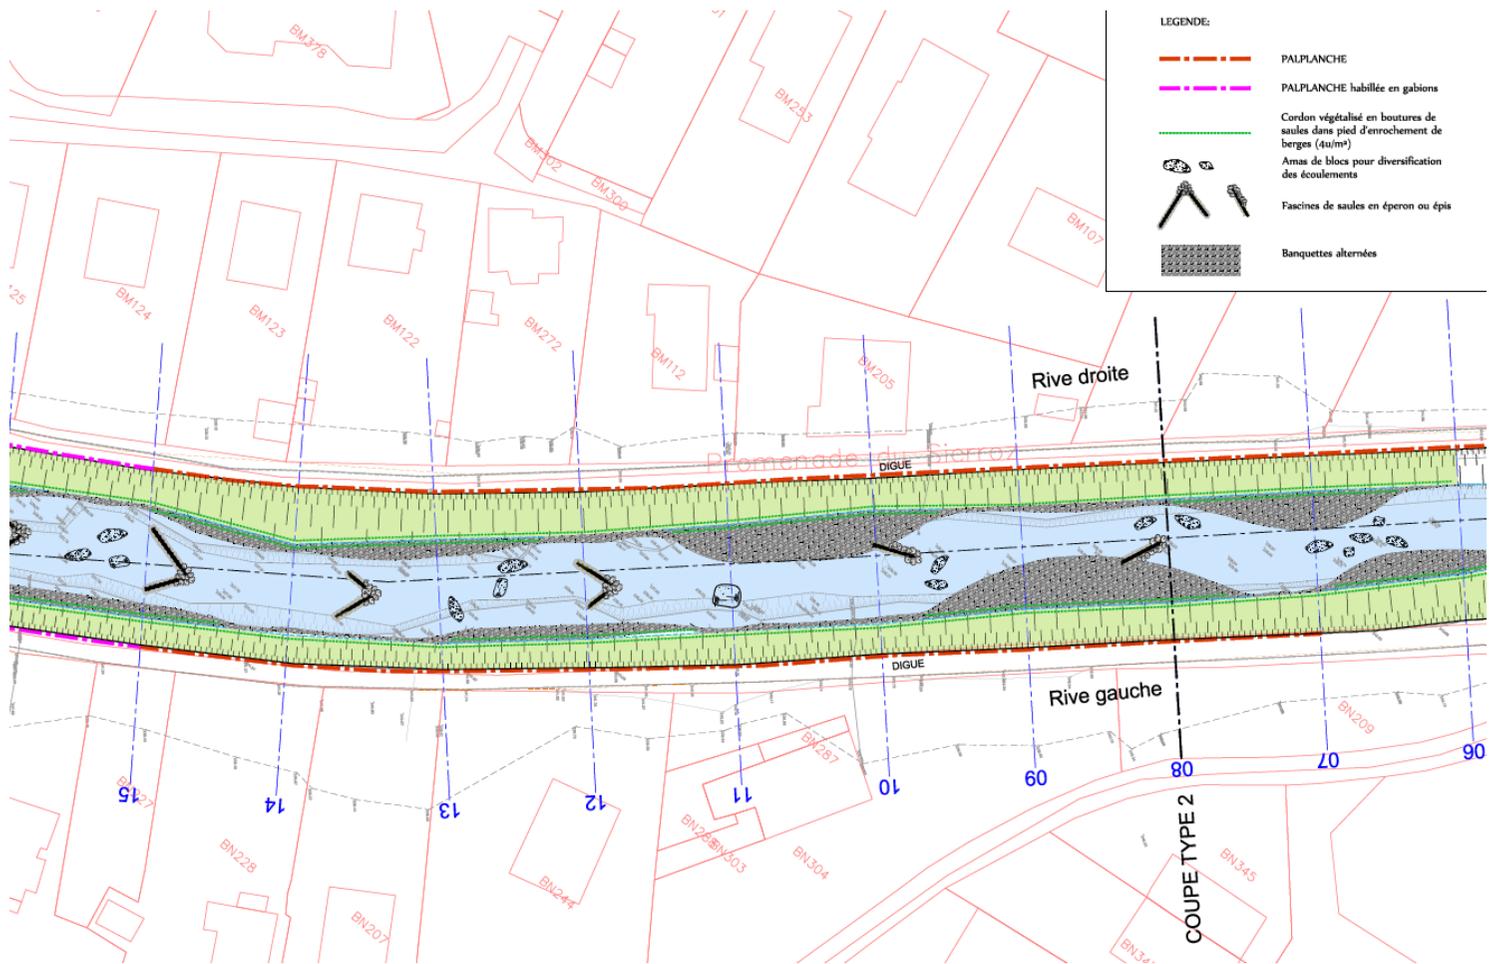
Vue en plan du confortement des digues du Sierroz – Planche de détail 2.2
